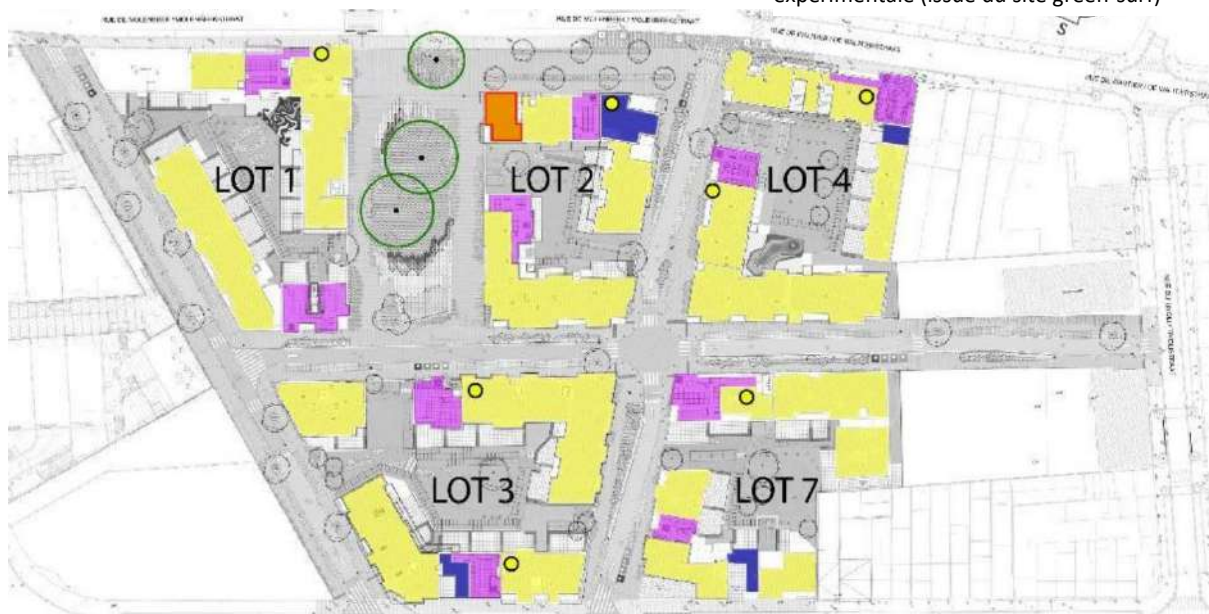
En mauve emplacement des toitures potagères (plan issu du Séminaire Bâtiment Durable : Bâti et biodiversité)
